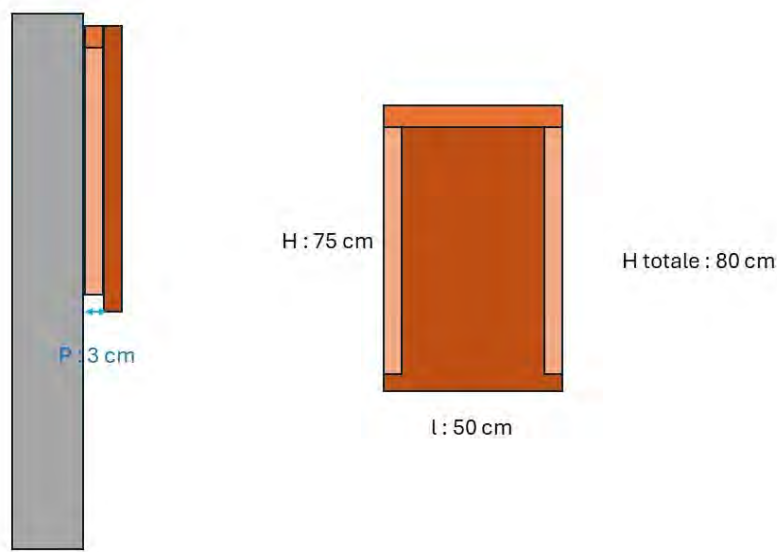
Plan d'un gîte artificiel en bois intérieur
